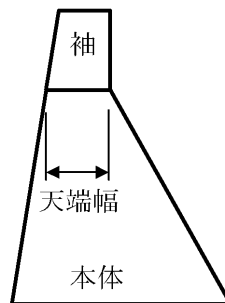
砂防堰堤側面図（事例）と部位名称
